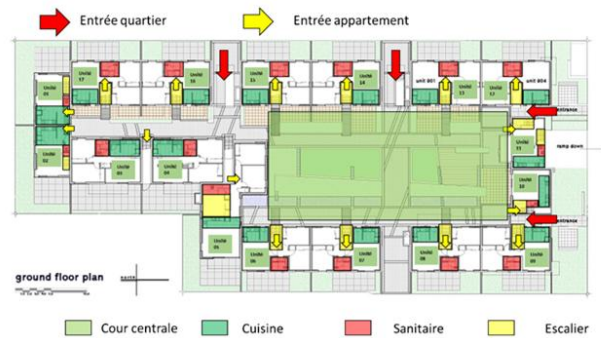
Plan de rez de chaussée. Source : Archdaily.
